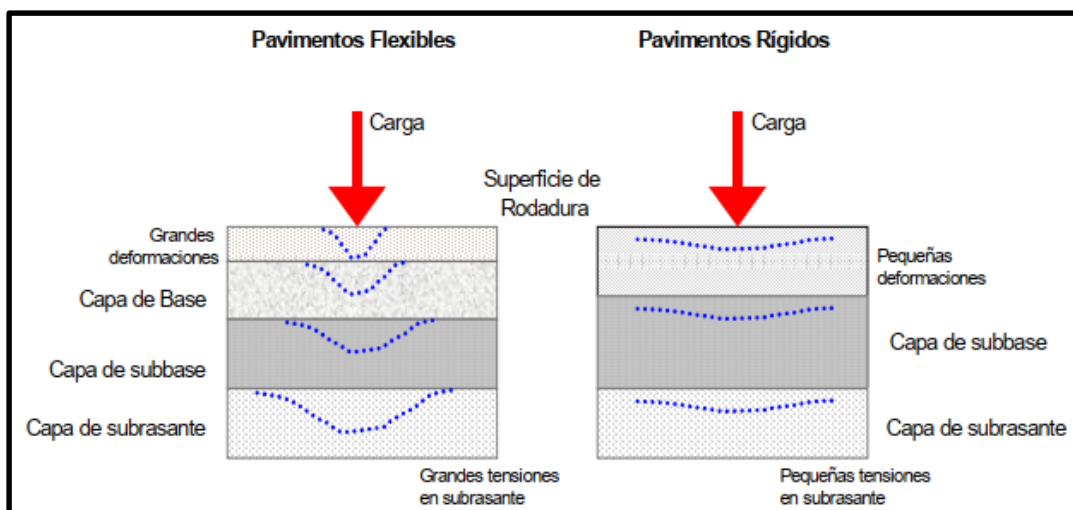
ESQUEMA DEL COMPORTAMIENTO DE PAVIMENTOS FLEXIBLES Y RÍGIDOS. FUENTE: MANUAL CENTROAMERICANO PARA DISEÑO DE PAVIMENTOS (SIECA).
